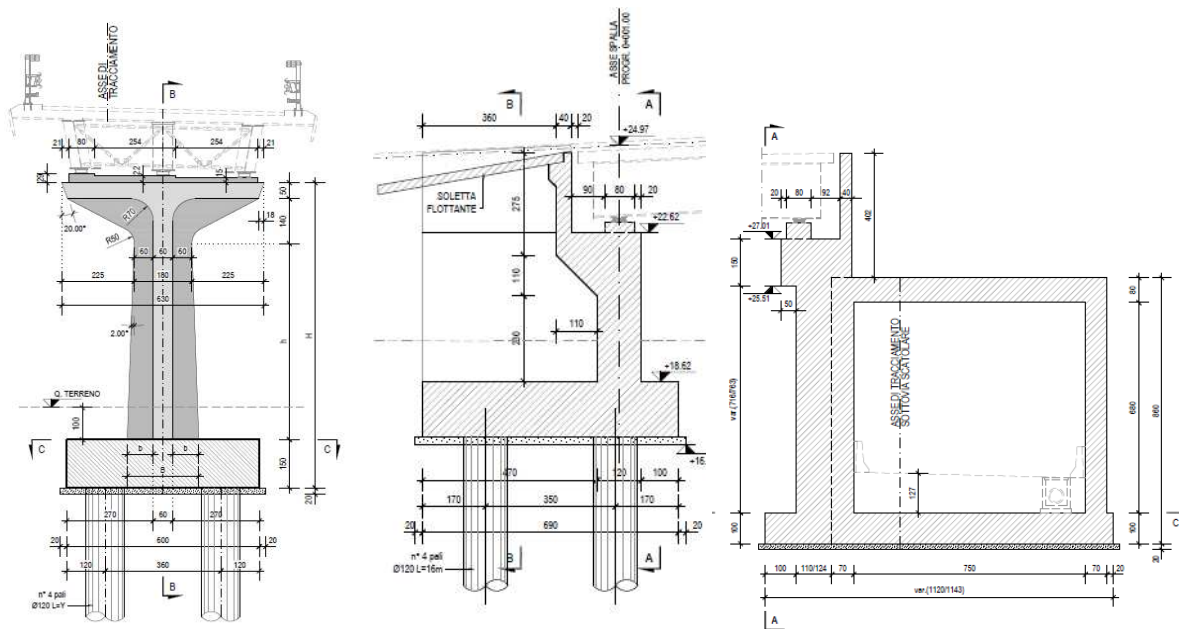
Carpenteria Pila tipologia e spalle
